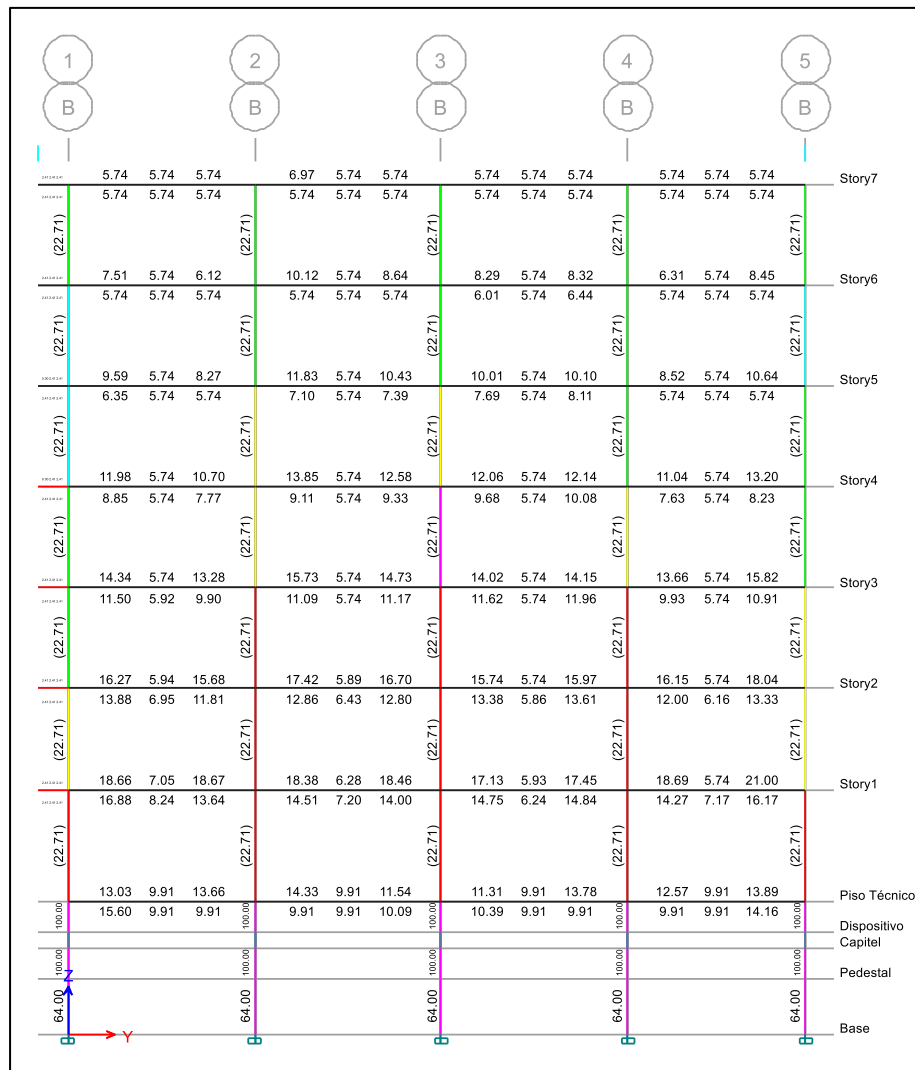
Cálculo de área de acero en vigas y columnas Eje B-B/1-5
